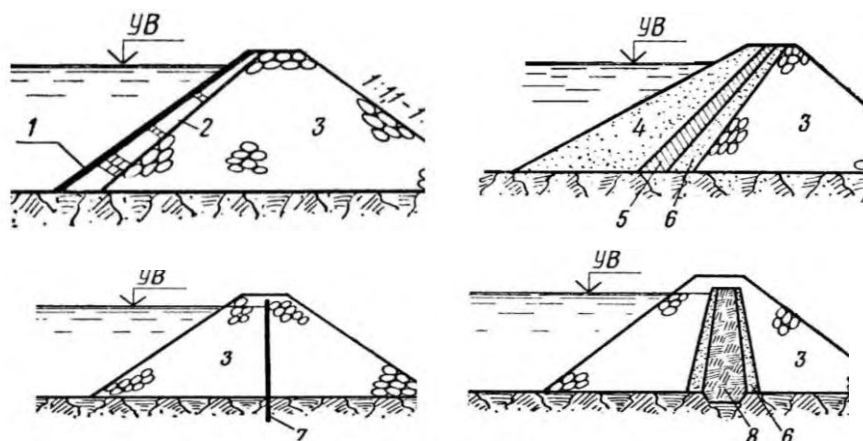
Варианты устройства классических схем ПФУ при ремонте земляной плотины или дамбы: 1 — экран; 2 — подэкрановая кладка; 3 — каменная наброска; 4 — пригрузка грунтом; 5 — пластичный (грунтовый) экран; 6 — обратный фильтр; 7 — диафрагма; 8 — ядро из маловодопроницаемого материала
